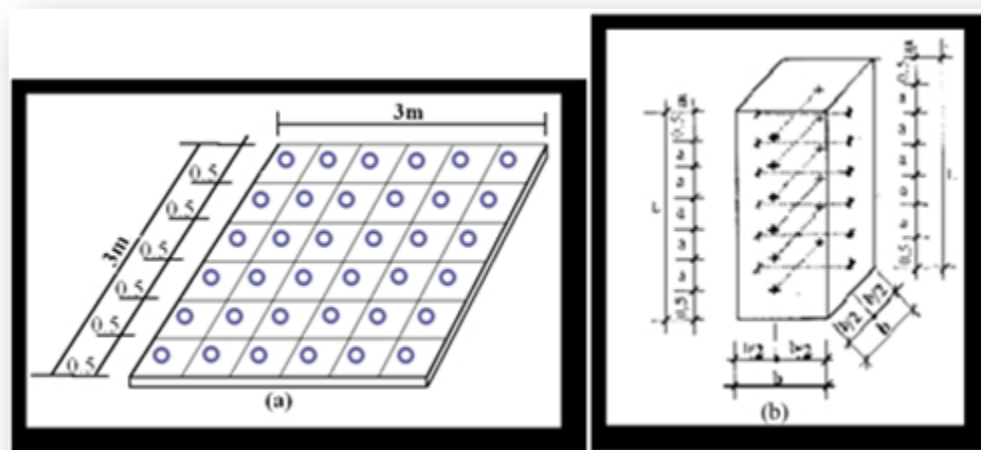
Points de mesures pour une dalle et un poteau. [47]
